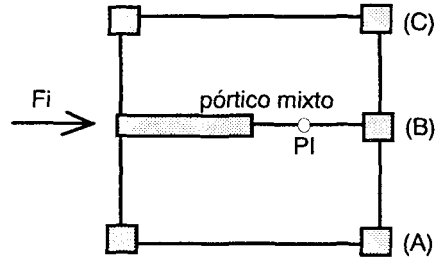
Planta de un Edificio con Pórtico Mixto
